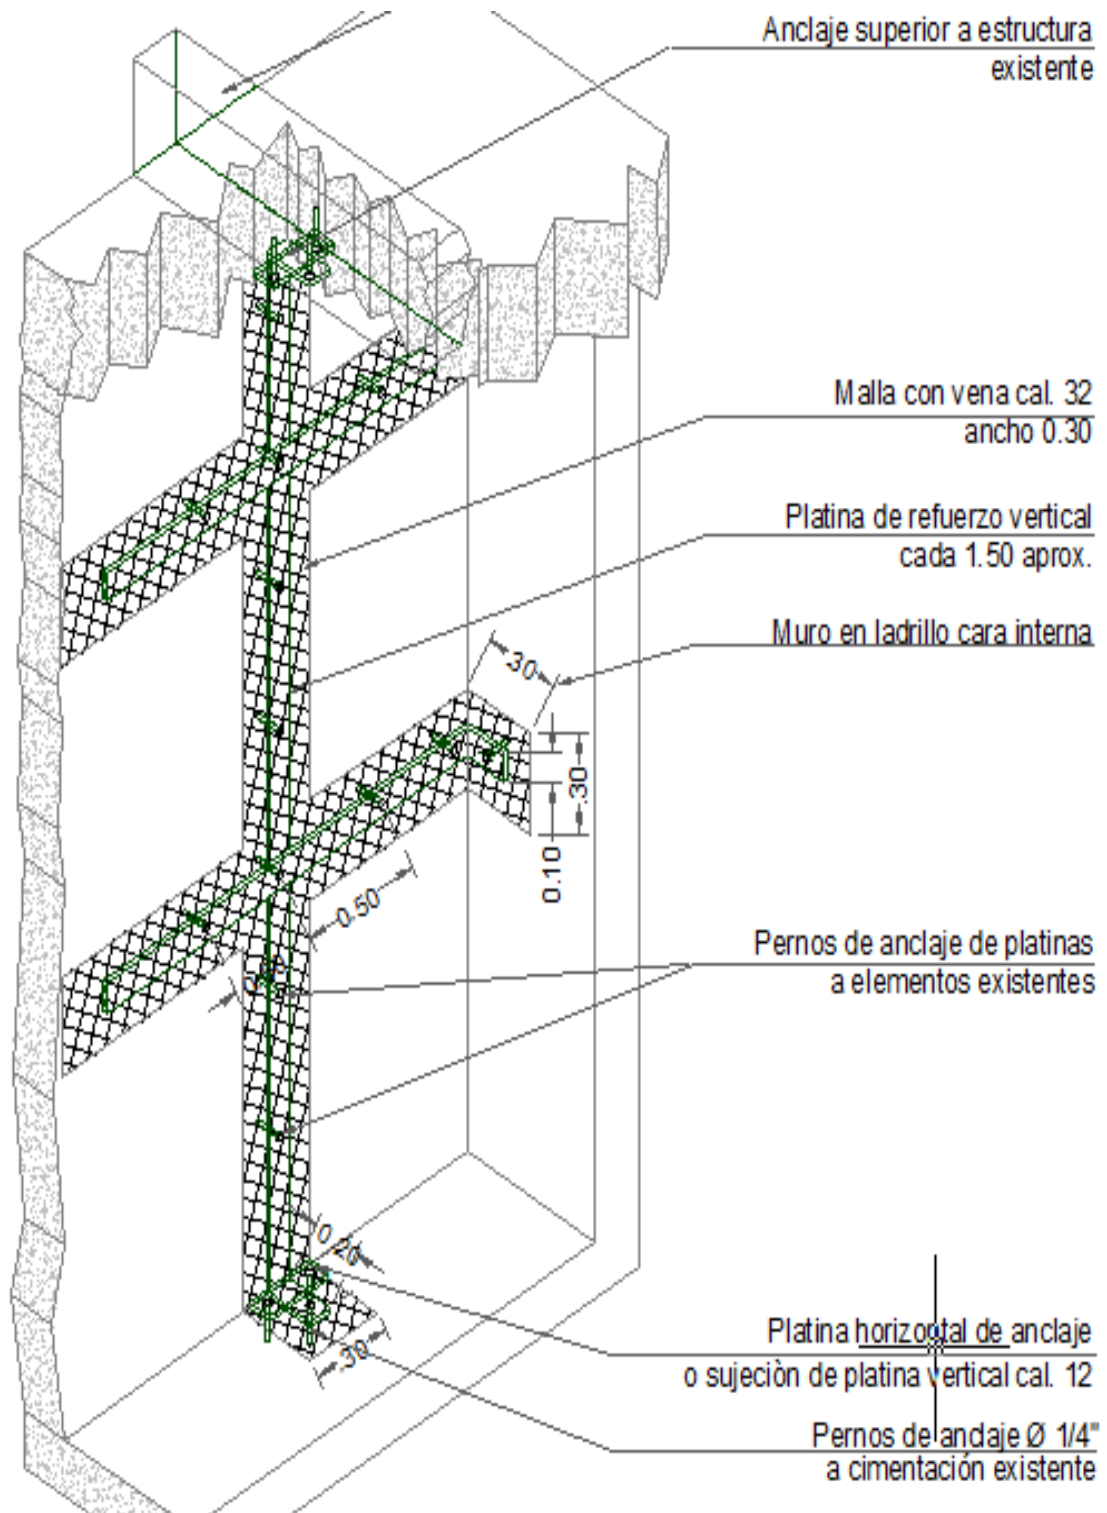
Detalle constructivo, del sistema de reforzamiento propuesto- perspectiva isométrica- vista desde el interior. Fuente: Elaboración propia
